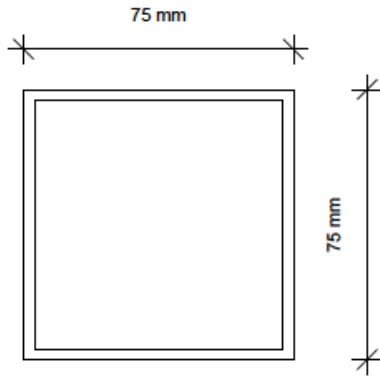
Perfil "O" de 75 mm x 75 mm x 3 mm
